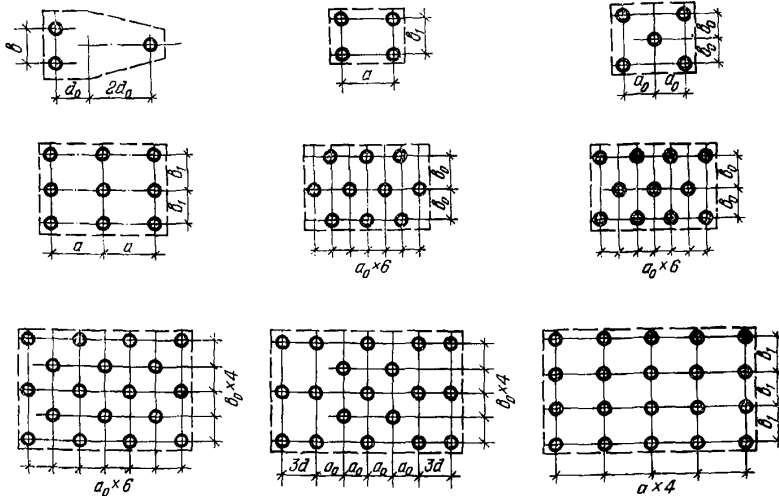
Примеры решений свайных фундаментов под колонны промышленных зданий при различном количестве свай в кусте
